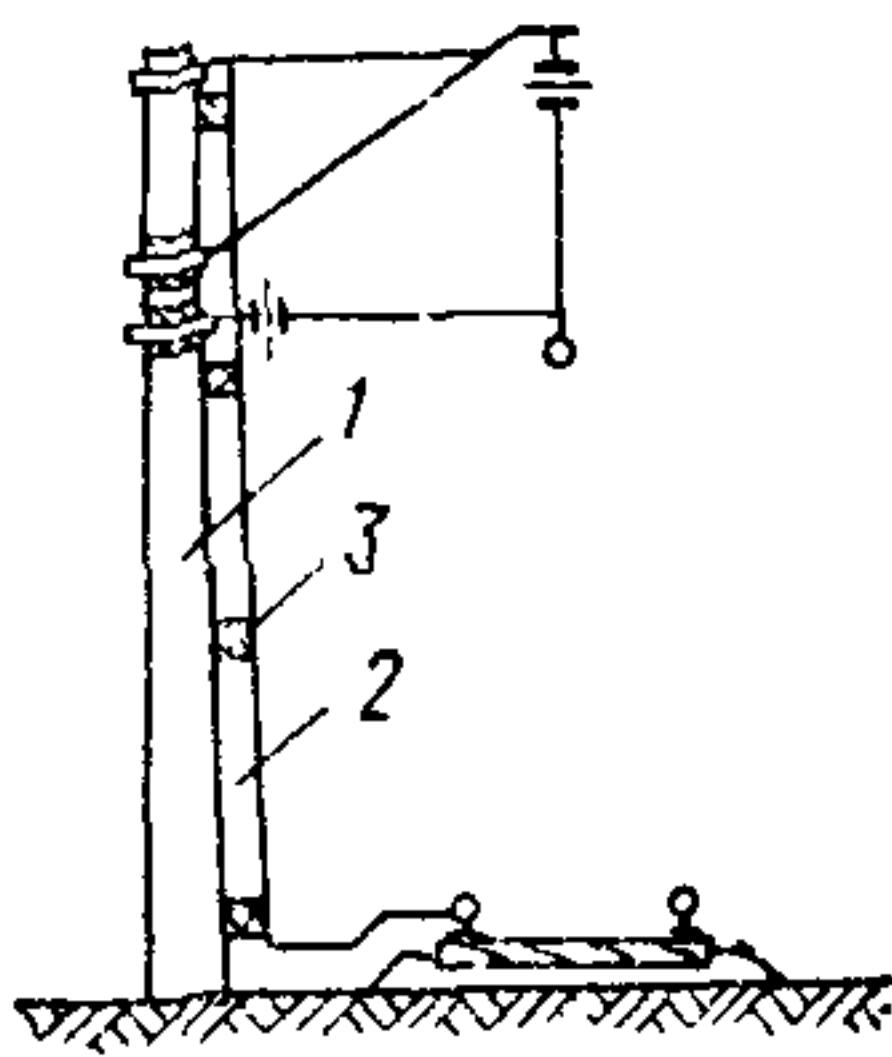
Изоляция заземляющего проводника от железобетонной опоры
